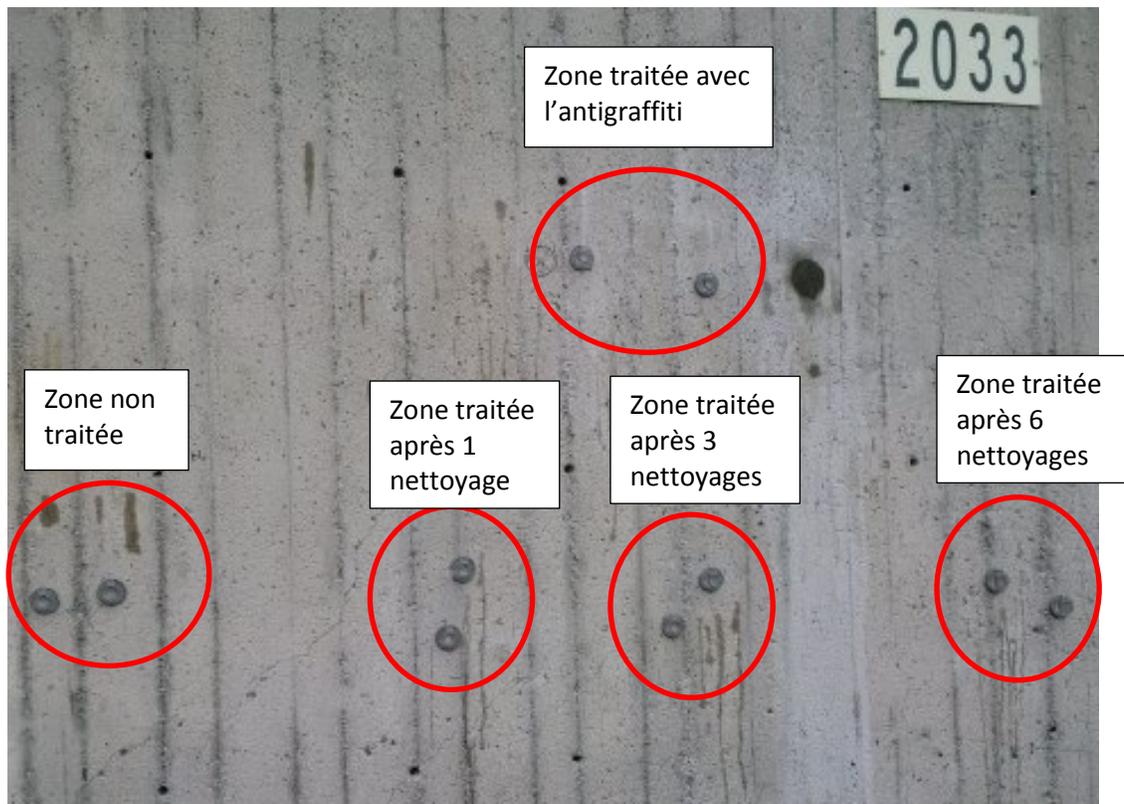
Test d'absorption d'eau (pipe de Karsten) dans les 5 zones du mur à l'essai
